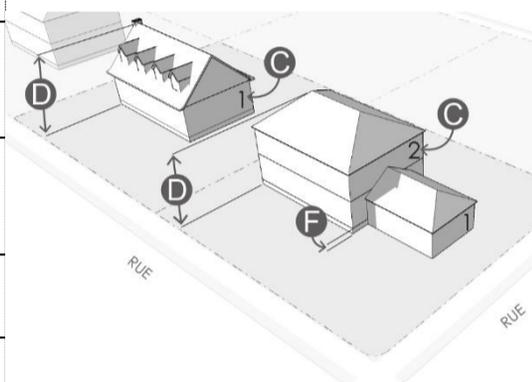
Hauteur d'un bâtiment et du plancher du rez-de-chaussée
